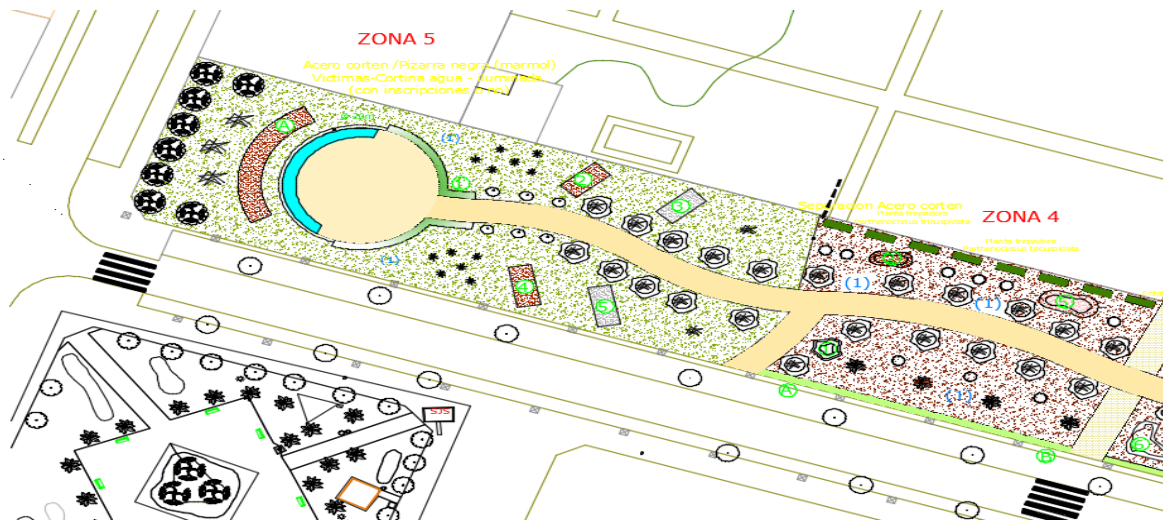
Planta de la zona 4 y 5 del diseño del parque.
